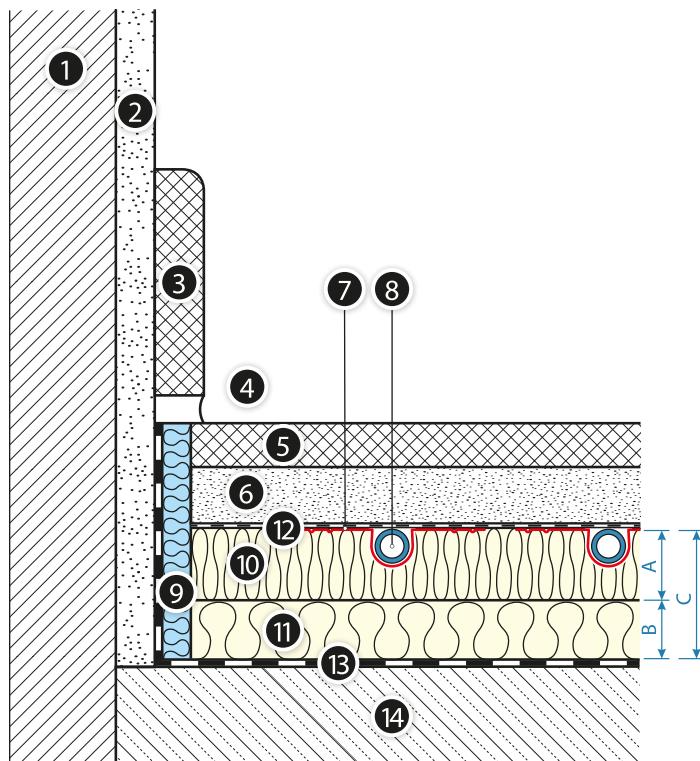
Напольный отопительный прибор с пенополистирольной плитой KAN-therm TBS и дополнительной изоляцией, а также гидроизоляционным покрытием на полу, на грунте
